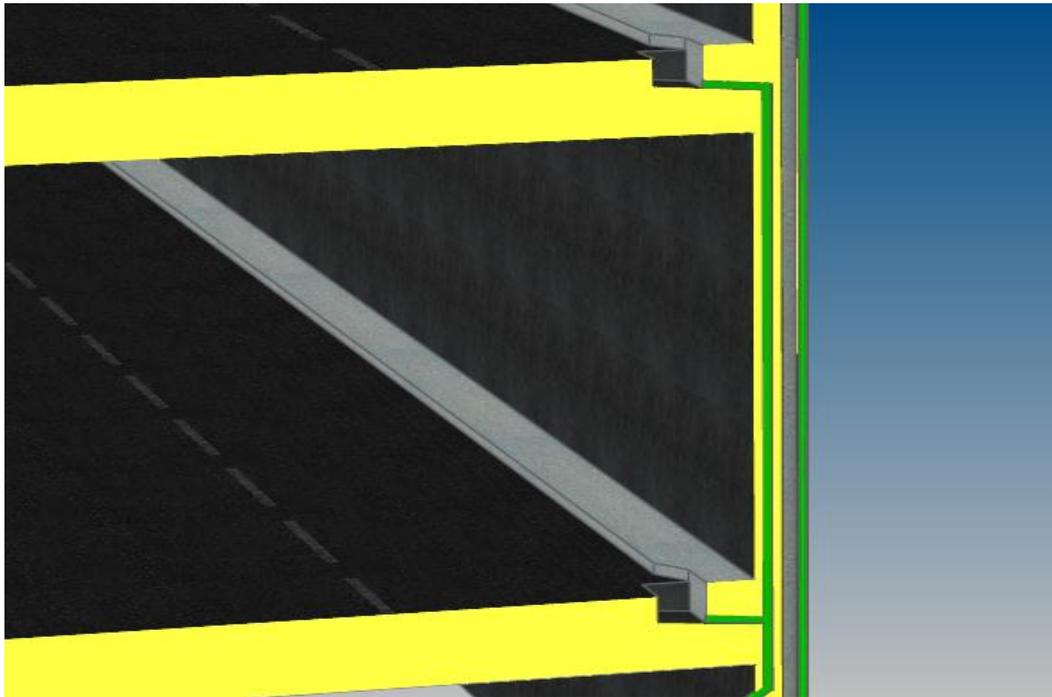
Esquema de Conexión de Cunetas Conductoras de Aguas entre las calzadas superior e inferior de la Trinchera Cubierta
